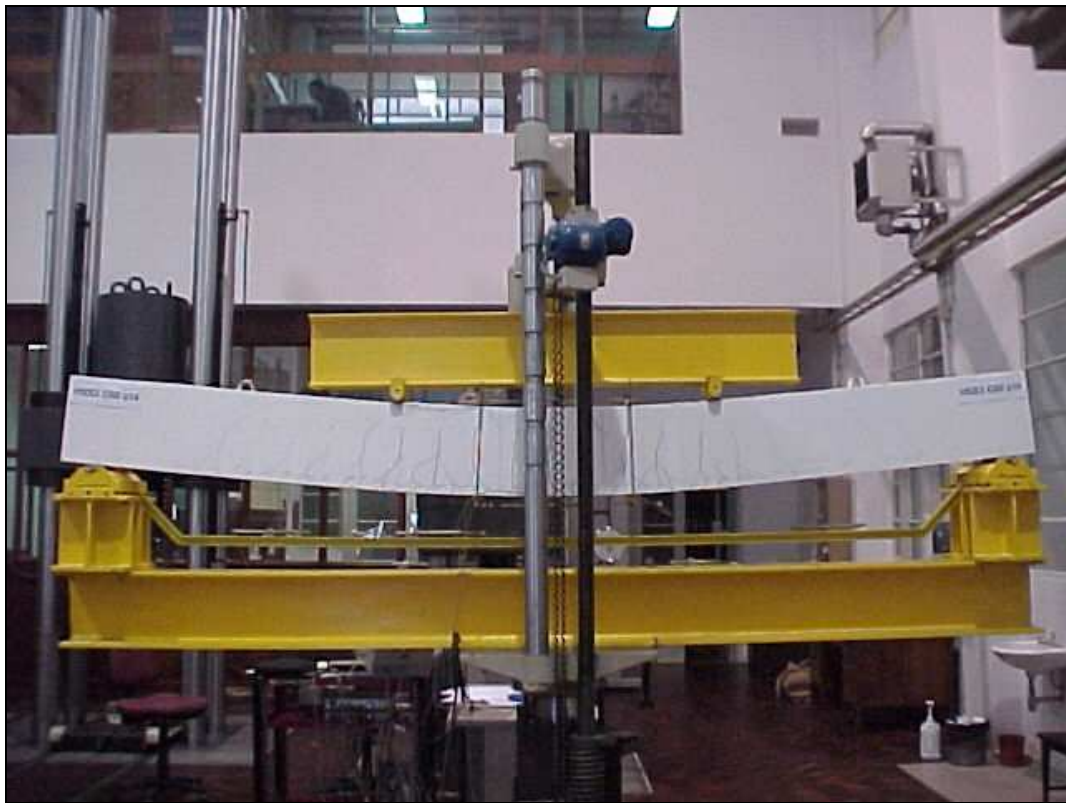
Posição final de ensaio da viga HSS3_C60_d14.
